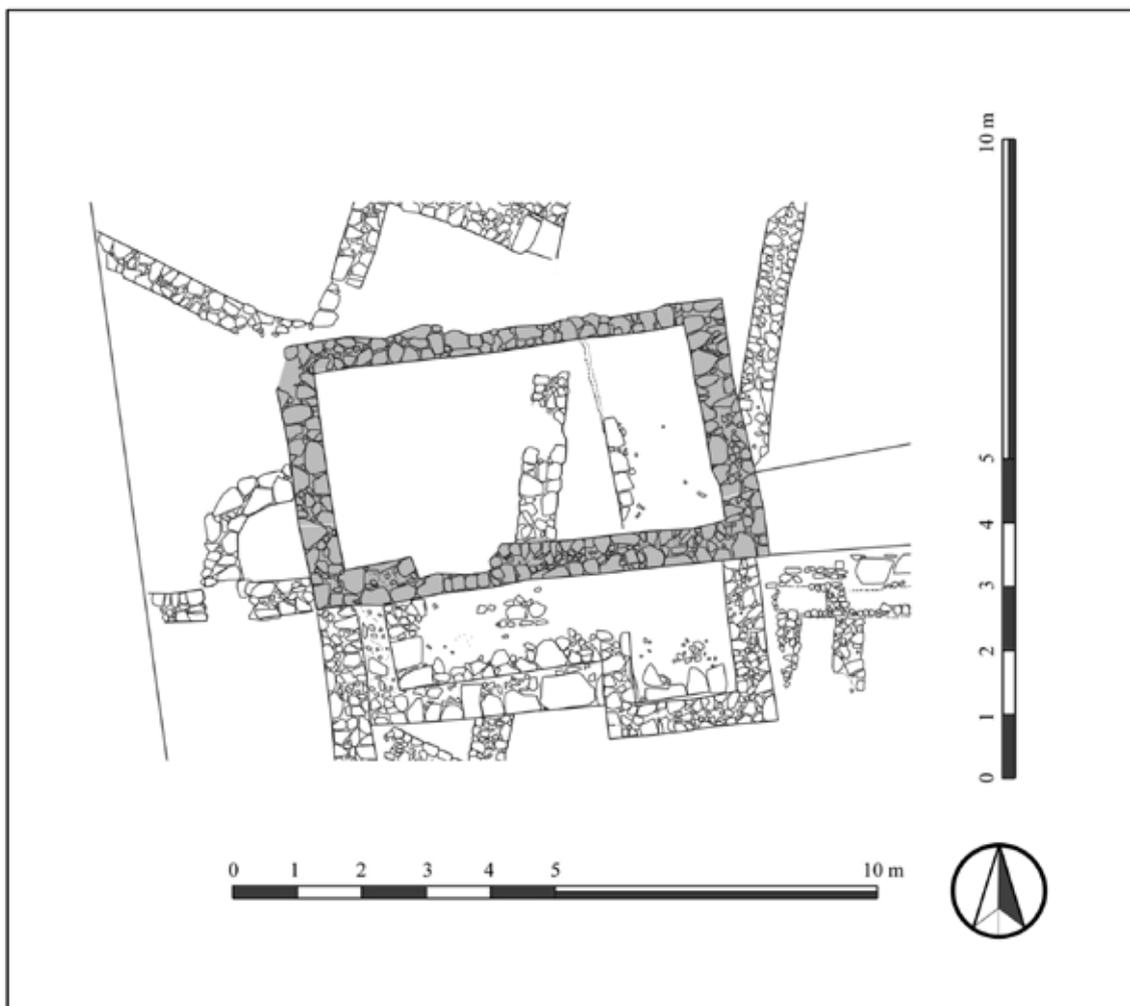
Planimetria del vano rettangolare e del corpo edilizio addossato al lato meridionale
